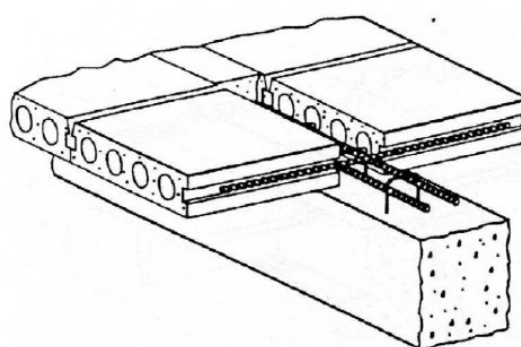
Ligação de lajes alveolares através de amarração em paralelo com a laje (PCI,2004)
